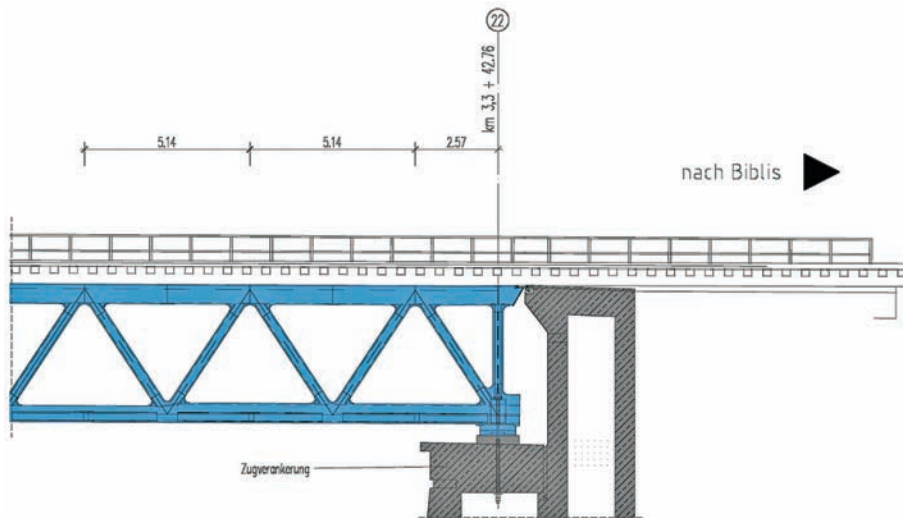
Detaillängsschnitt Achse 22 (Abbildung: privat)
